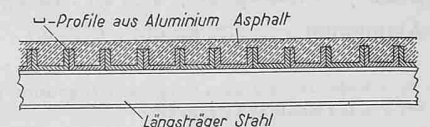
Fahrbahnrost aus Leichtmetall, Klappbrücke bei Bridgeport
